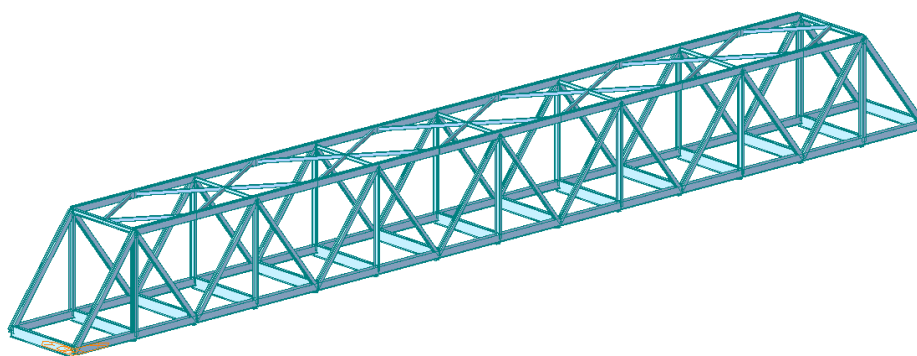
Modelo estructural del antiguo puente Chupuro
